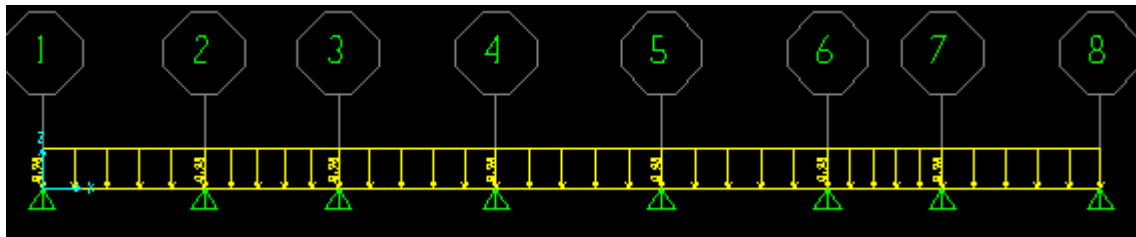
schéma statique de la poutrelle a plusieurs travées
